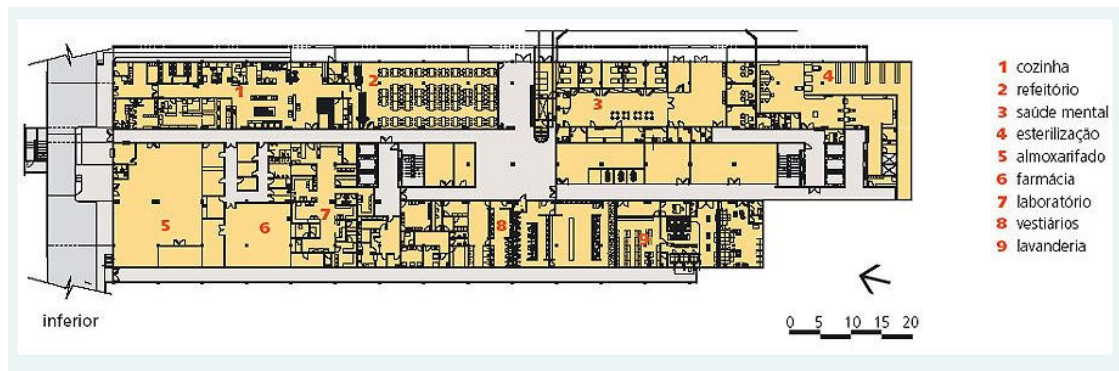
Planta baixa - subsolo (FIGUEROLA, 2007).
